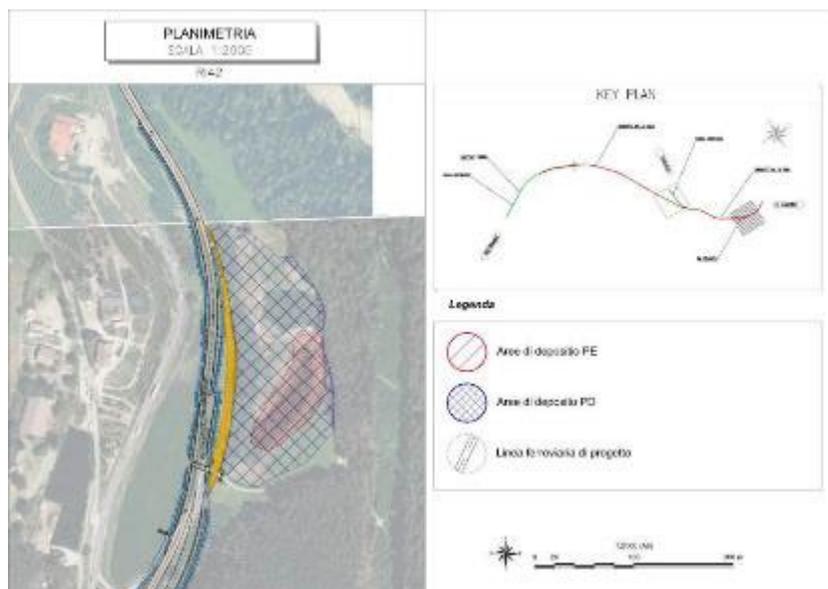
Confronto in planimetria dell'area tra fase di PD e fase di PE
